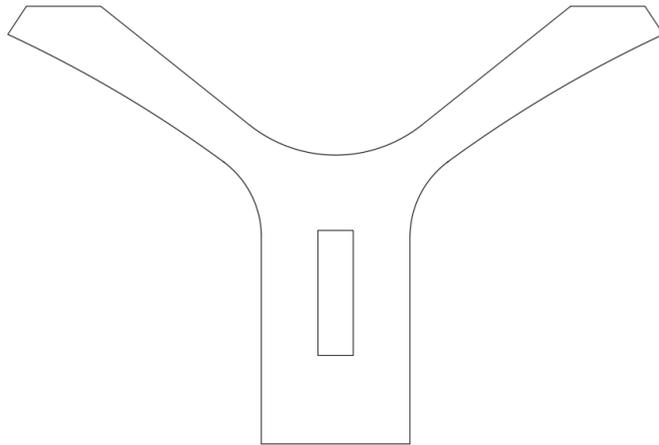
Pila número 2. (Fuente: elaboración propia en AutoCAD).
